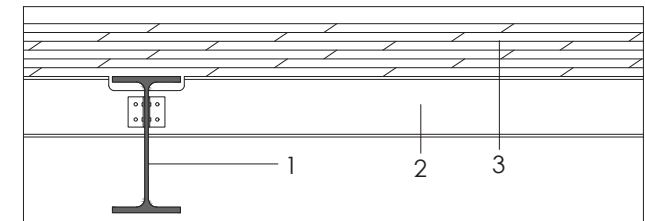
Stratigrafia caso studio. (1) Trave principale IPE 360, (2) trave secondaria IPE 160, (3) Solaio X-LAM altezza 14 cm; Scala 1:20; Fonte: elaborazione personale;
